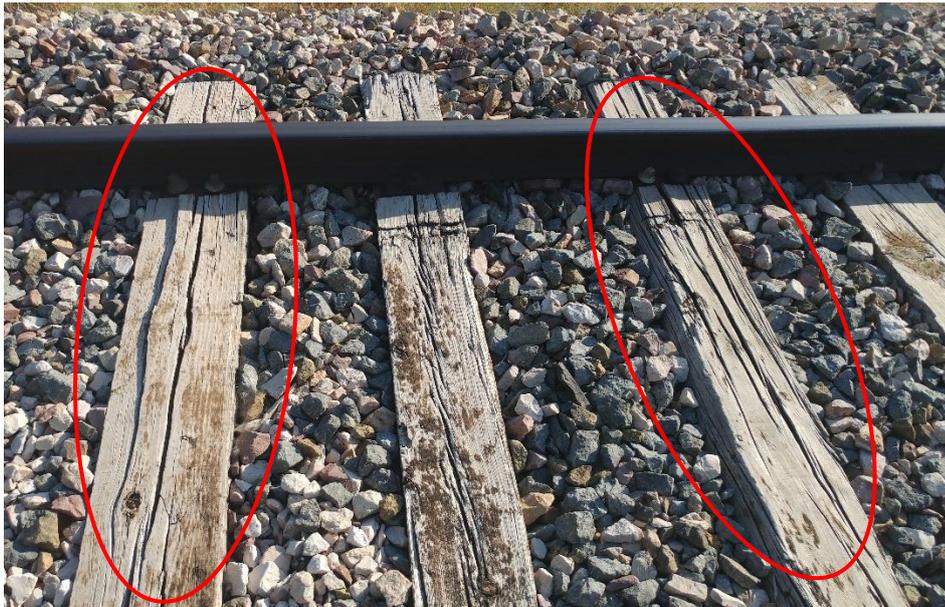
Ejemplo de traviesas fisuradas [imagen tomada en visita a vía]
